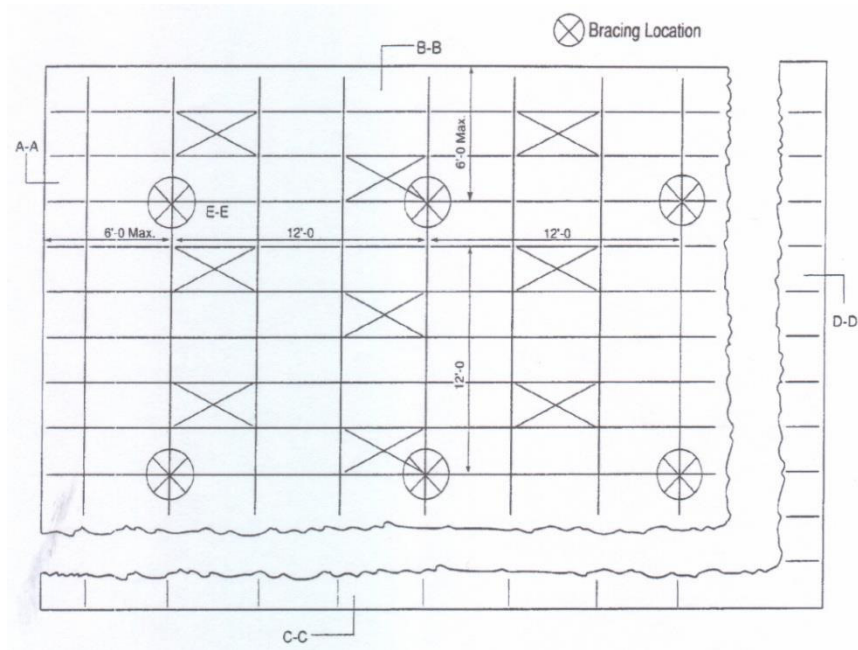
“Bracing Location” (alambres para fuerzas laterales, ubicación):
